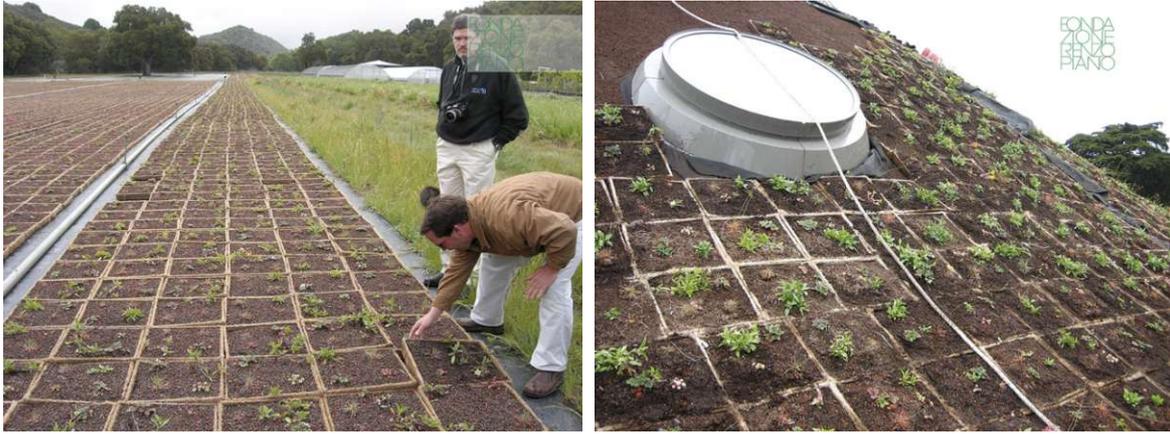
links: Aufzucht in Pflanzenschalen © RPBW - Renzo Piano Building Workshop Architects [90] und rechts: Pflanzenschalen installiert © RPBW - Renzo Piano Building Workshop Architects [90]
